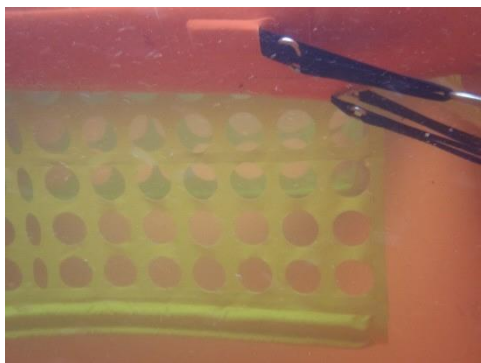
Cortina na câmara transversal nº. 4 Foto subaquática.
